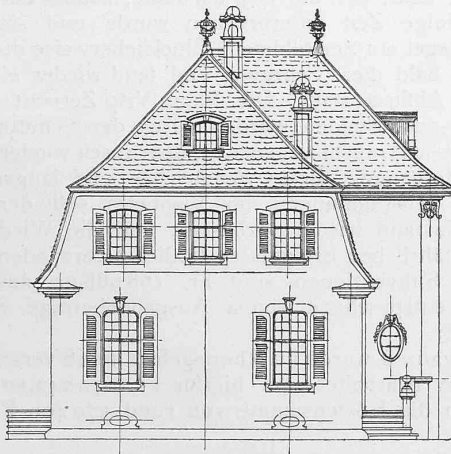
Façade latérale de la villa Lugeon. — Echelle 1 : 200. Architectes MM. Schmid et Rosset, Lausanne et Veytaux.
